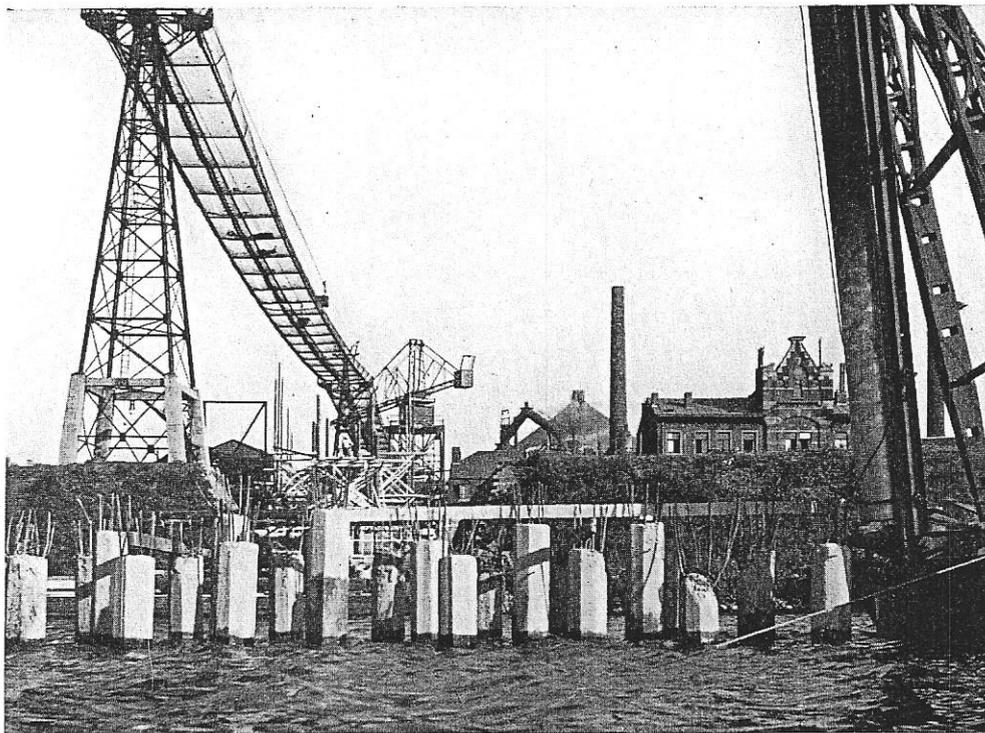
BATTAGE DES PIEUX MIXTES de l'une des piles en rivière. A droite, la sonnette Franki qui exécute ce travail.
